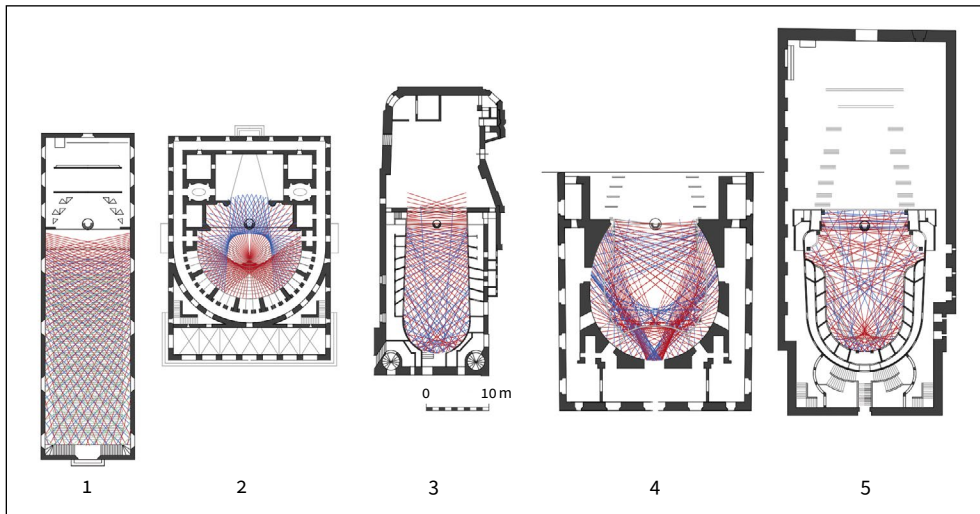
Grundrissstypen von Theatern: 1 Rechteck: Ulm, Stadttheater, 1641, Joseph Furtenbach d. Ä.; 2 Halbkeis: Projekt 1762, Vincenzo Arnaldi: Halbkreis mit 5 Logenrängen (Masse des Grundrisses hier wie St. Petersburg, halbrundes Theater in der Eremitage 1785); 3 U-Form: Wien, Burgtheater 1756, Fr. W. Weisskerns; 4 Gekapptes Oval: Schönbrunn bei Wien, Schlosstheater 1767 (Reflexionen an der Rangbrüstung und an den Saalwänden); 5 Lyra: Bayreuth, Markgräflisches Opernhaus 1748.
